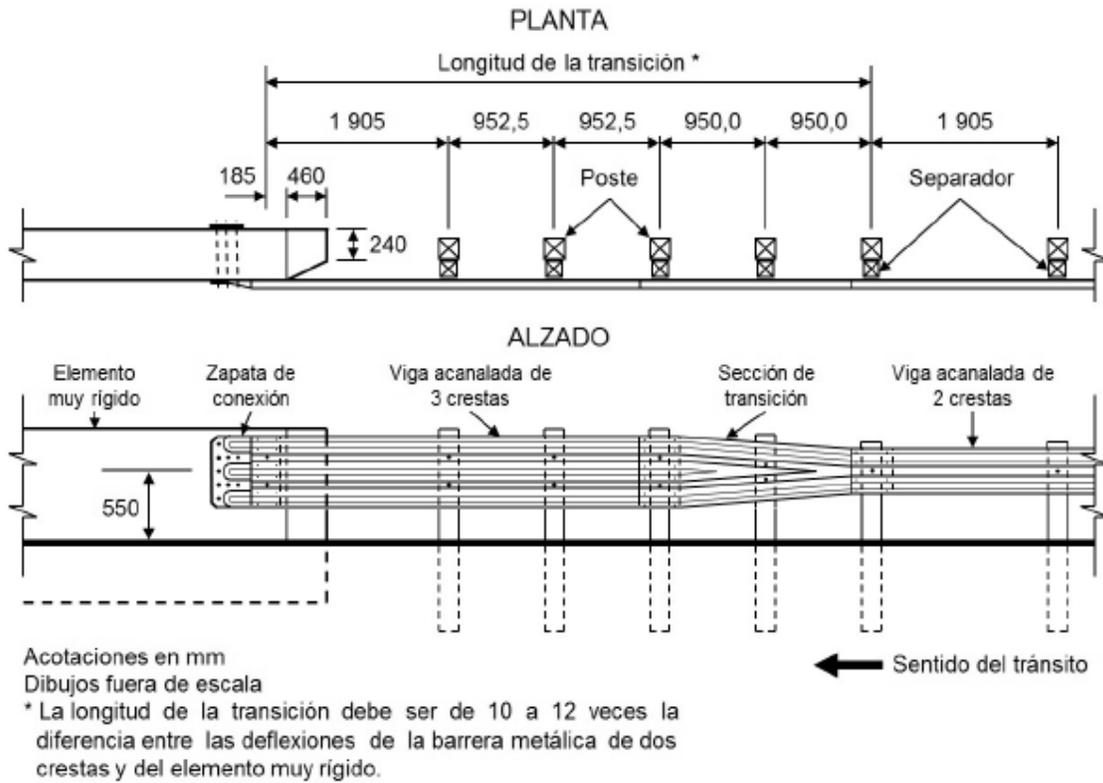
Transición de barrera metálica de dos a tres crestas y a muro vertical recto
